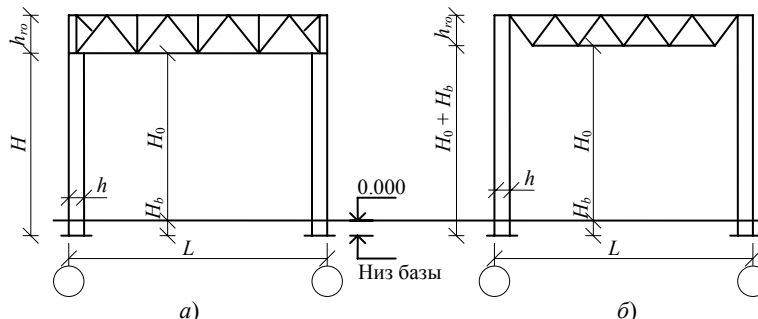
Схема поперечной рамы при опирании фермы в уровне верхнего (а) и нижнего (б) поясов
